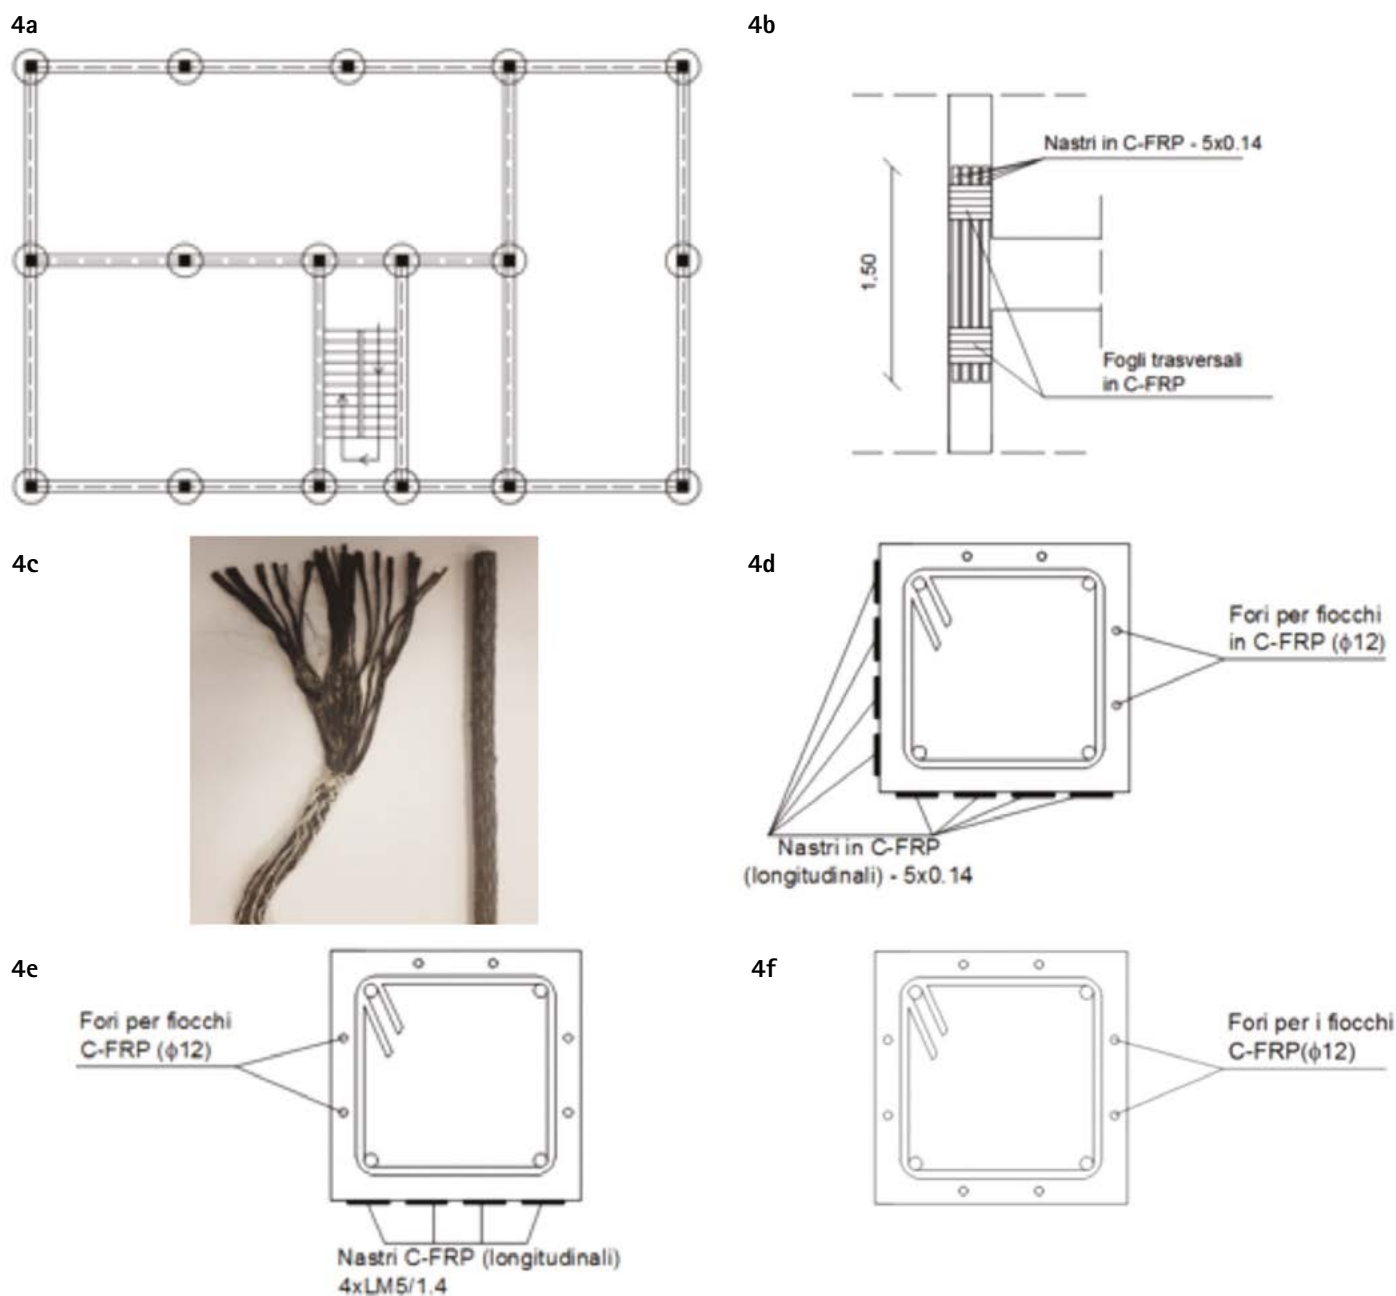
a) pilastri interessati dall'intervento con i C-FRP; b) particolare del rinforzo con C-FRP sulla faccia del pilastro; c) fiocco in C-FRP; d) sezione trasversale pilastro d'angolo; e) sezione trasversale pilastro perimetrale; f) sezione trasversale pilastri con tutte le quattro facce bloccate
